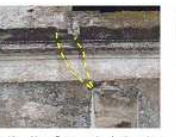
Idem. Pormenor das fendas subverticais, acima da abertura do piso intermédia.
